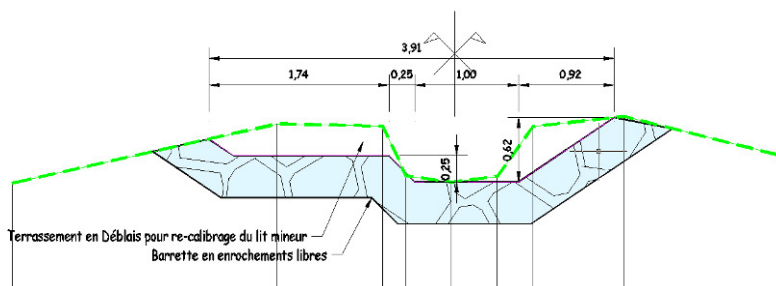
Coupe type aménagement n°3 - Barrette en enrochement
